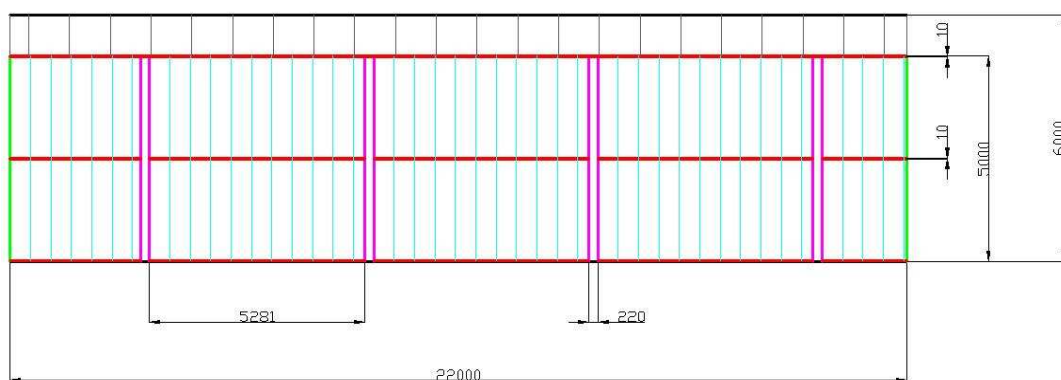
Ukázka realizace opláštění budovy [5]
